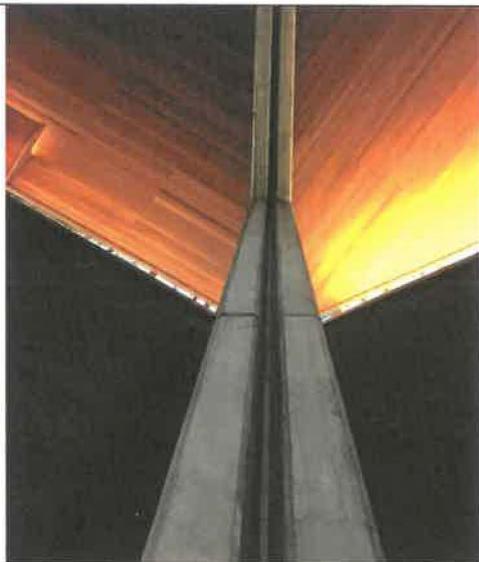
Vertikale Ansicht der zweiteiligen Betonträger; die Schalungsabdrücke im Beton entsprechen motivisch der Holzverkleidung der Decke.
